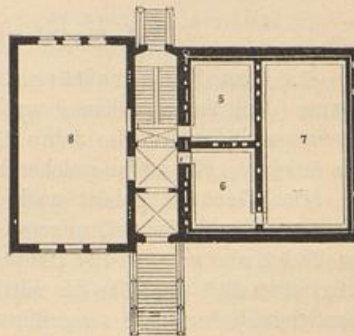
Grundriss vom Erdgeschoss. Fig. 77. Grundriss vom Hauptgeschoss.
